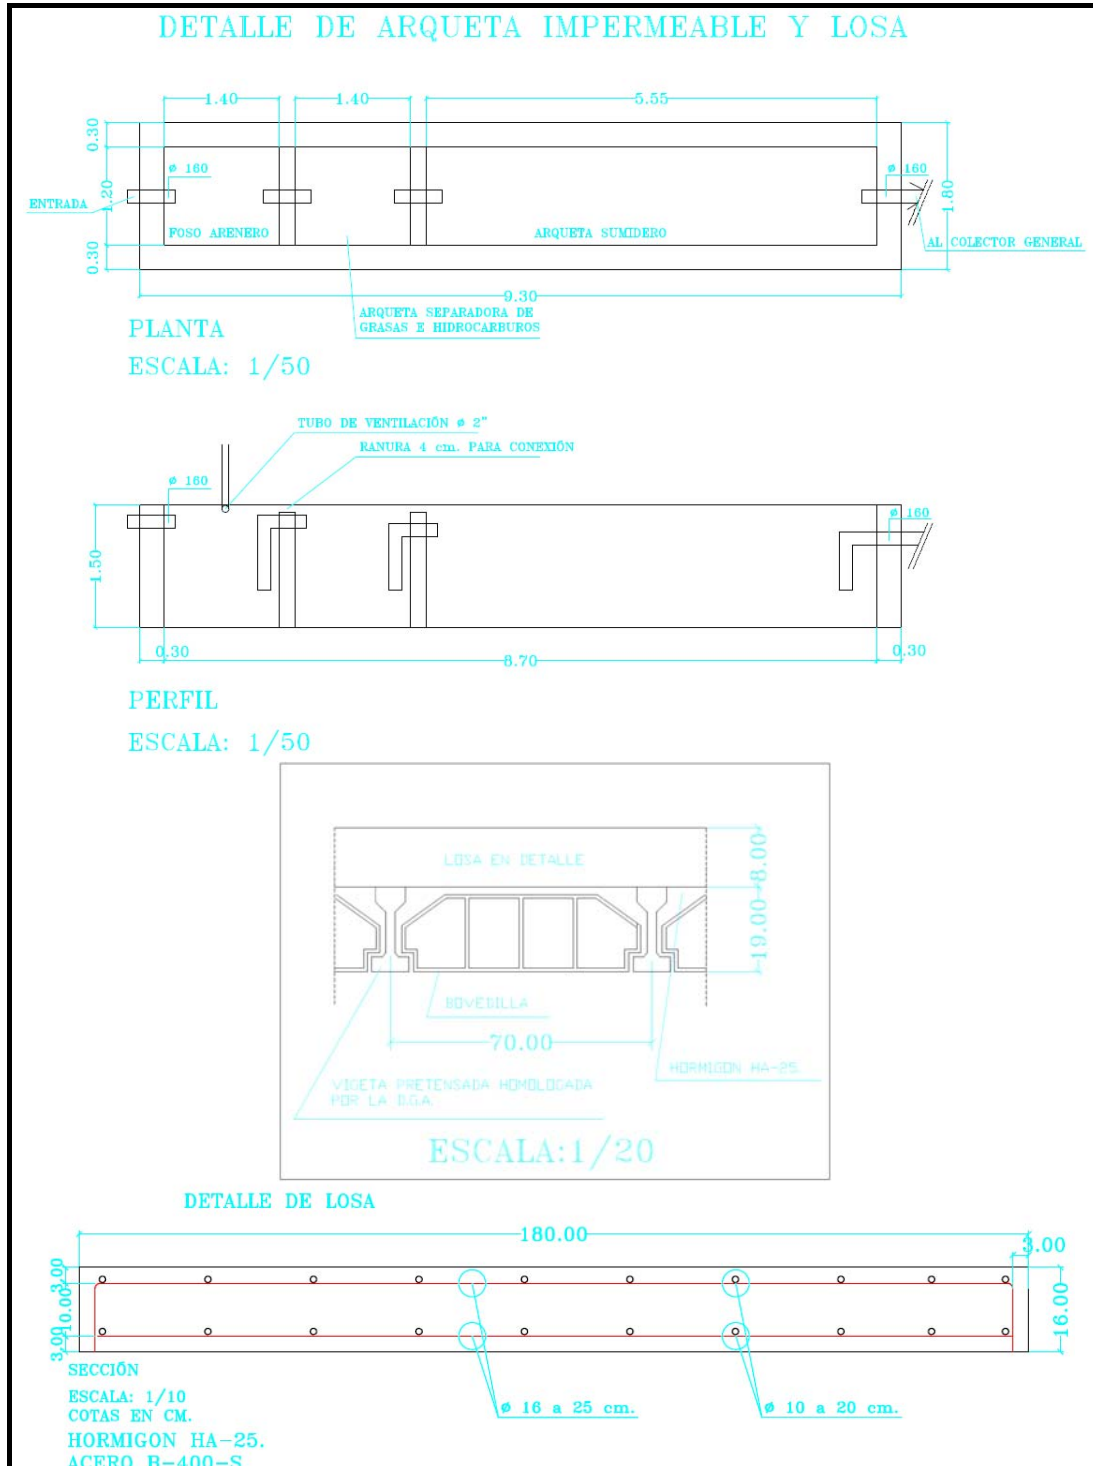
Separador de obra construido in situ. Fuente: Propia (2003).
